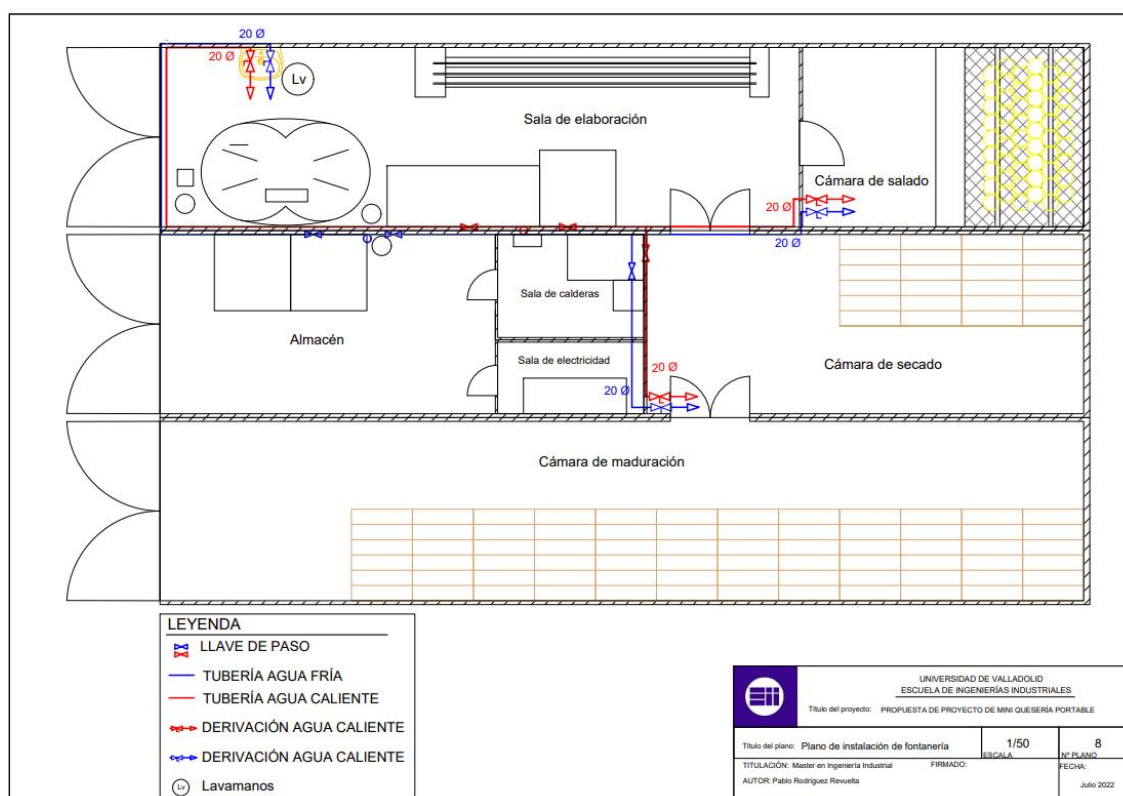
B - Plano de fontanería / Fuente: Elaboración propia
